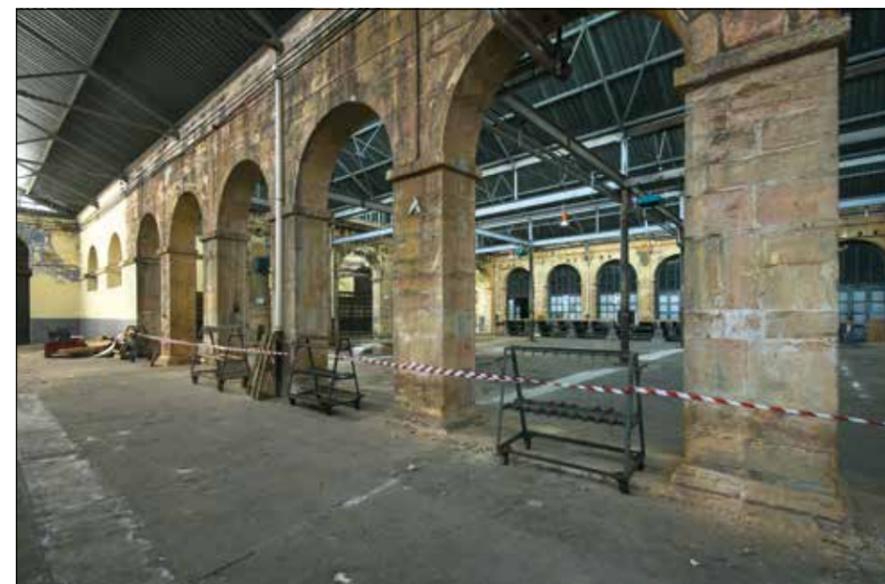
Santa María de la Vega, claustro oeste. Particular del lado interior de la arquería. Foto: los autores.
